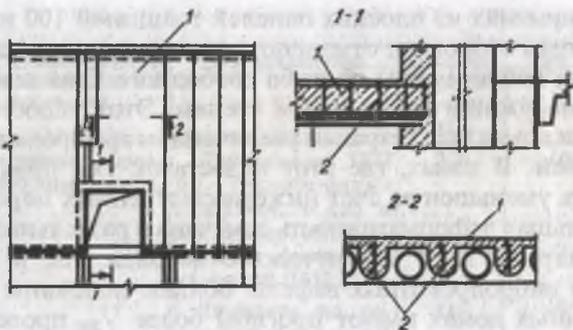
Устройство проема в перекрытии из многопустотного настила:
